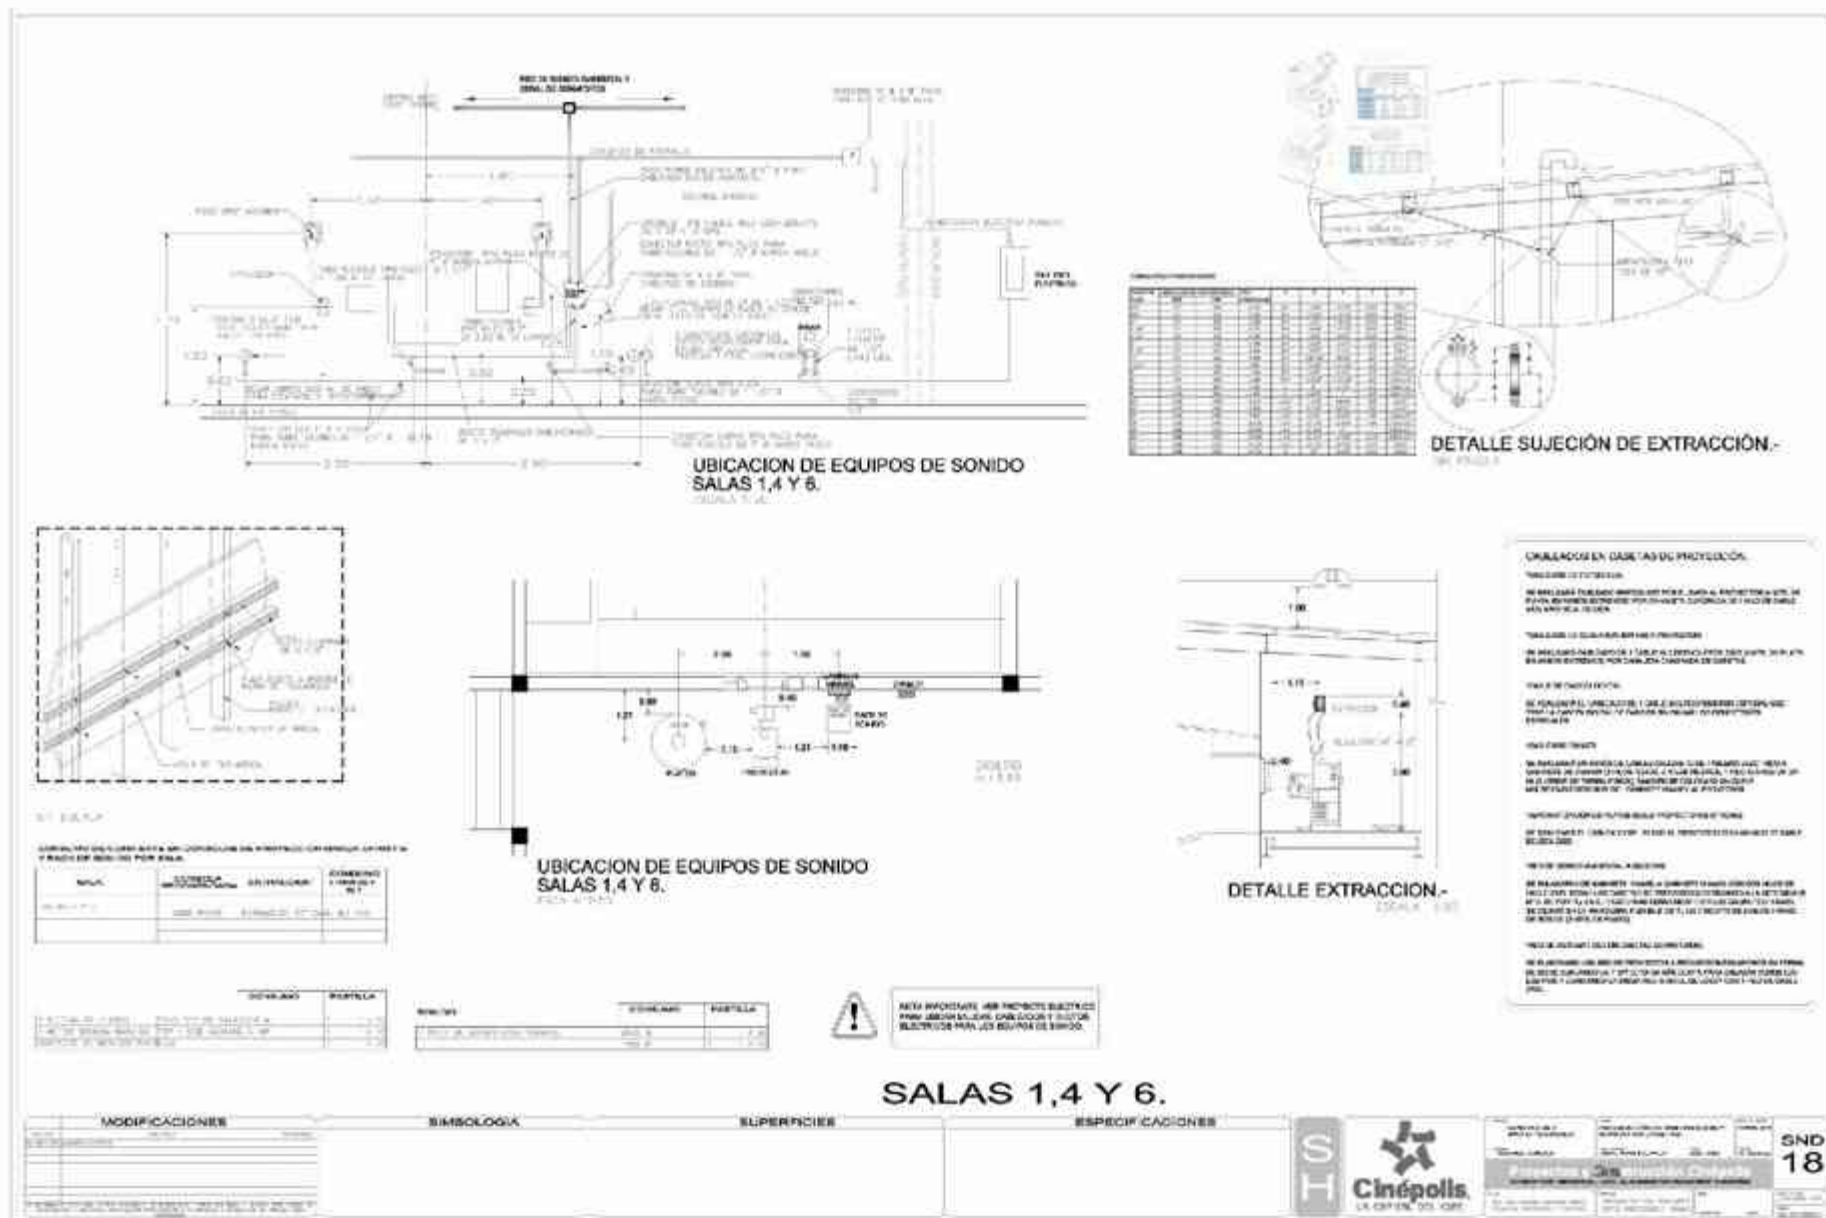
SND-18 Alzados de casetas salas 1,4 y 6.
